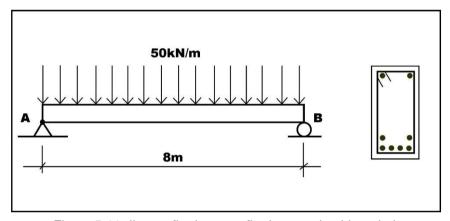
Ilustração da armação de uma viga bi-apoiada
